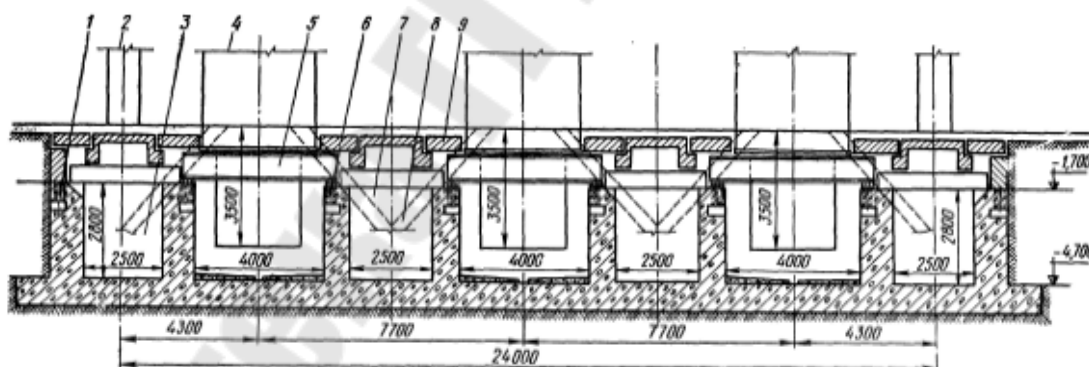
Схема трех траншейных фундаментов в сочетании с туннелями:
